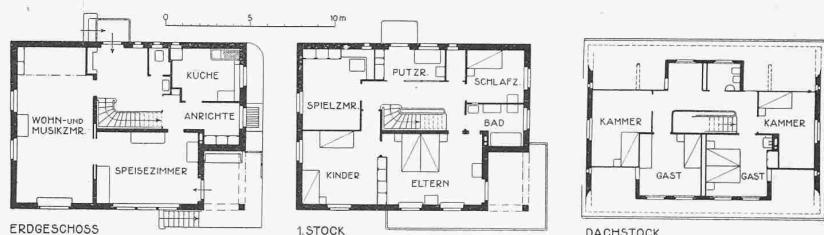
Grundrisse. — Masstab 1 : 400.
